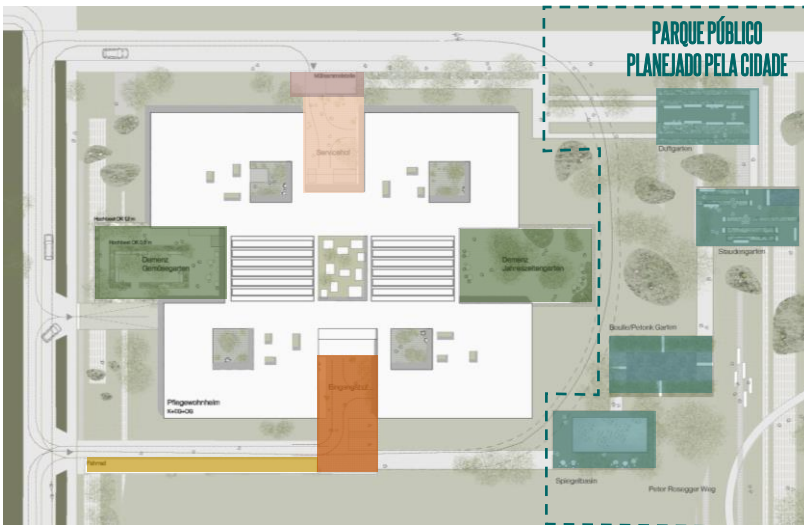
Planta de situação com esquema de usos externos. Fonte: ArchDaily. Esquema elaborado pela autora. 2020.
